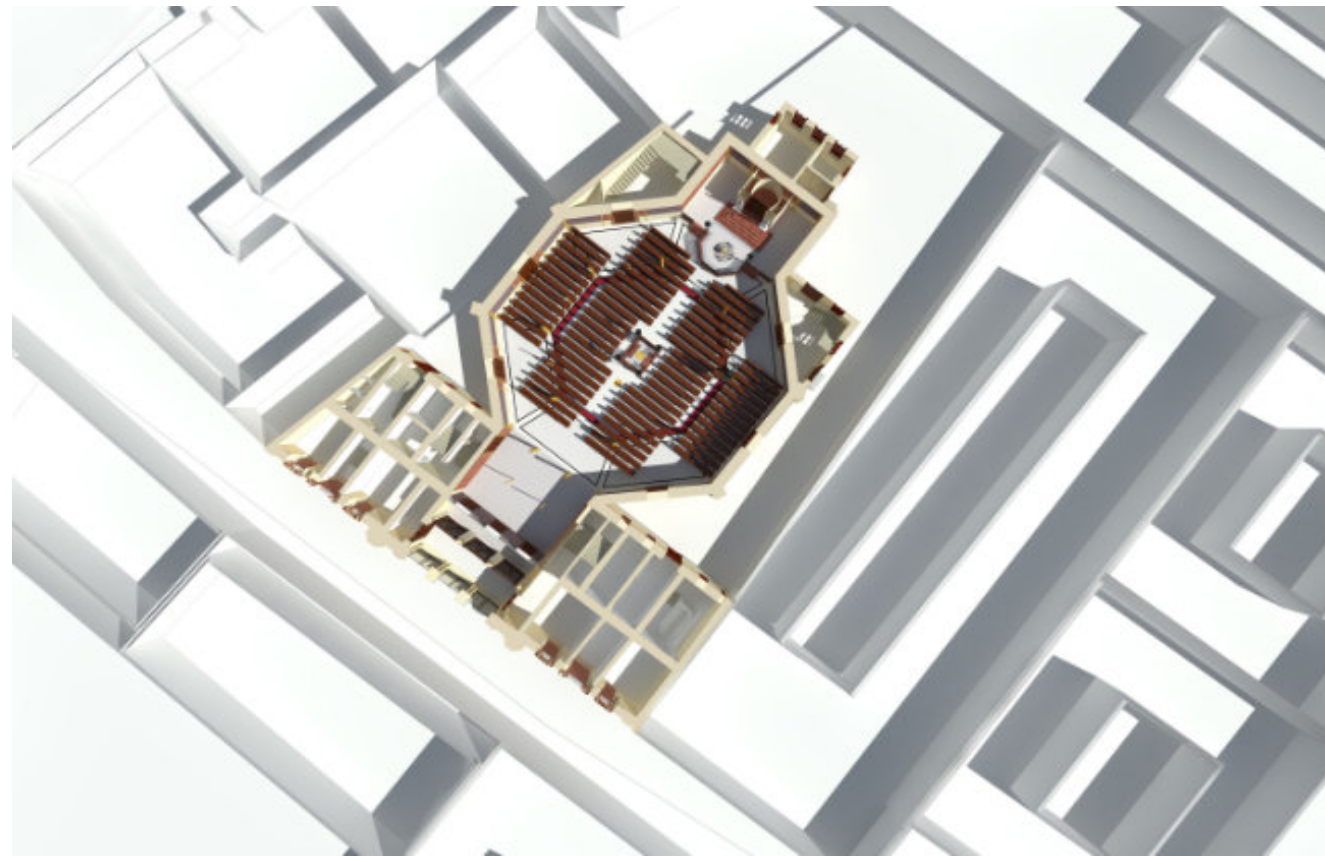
27.: 3D Grundriss - Erdgeschoß, Visualisierung.
